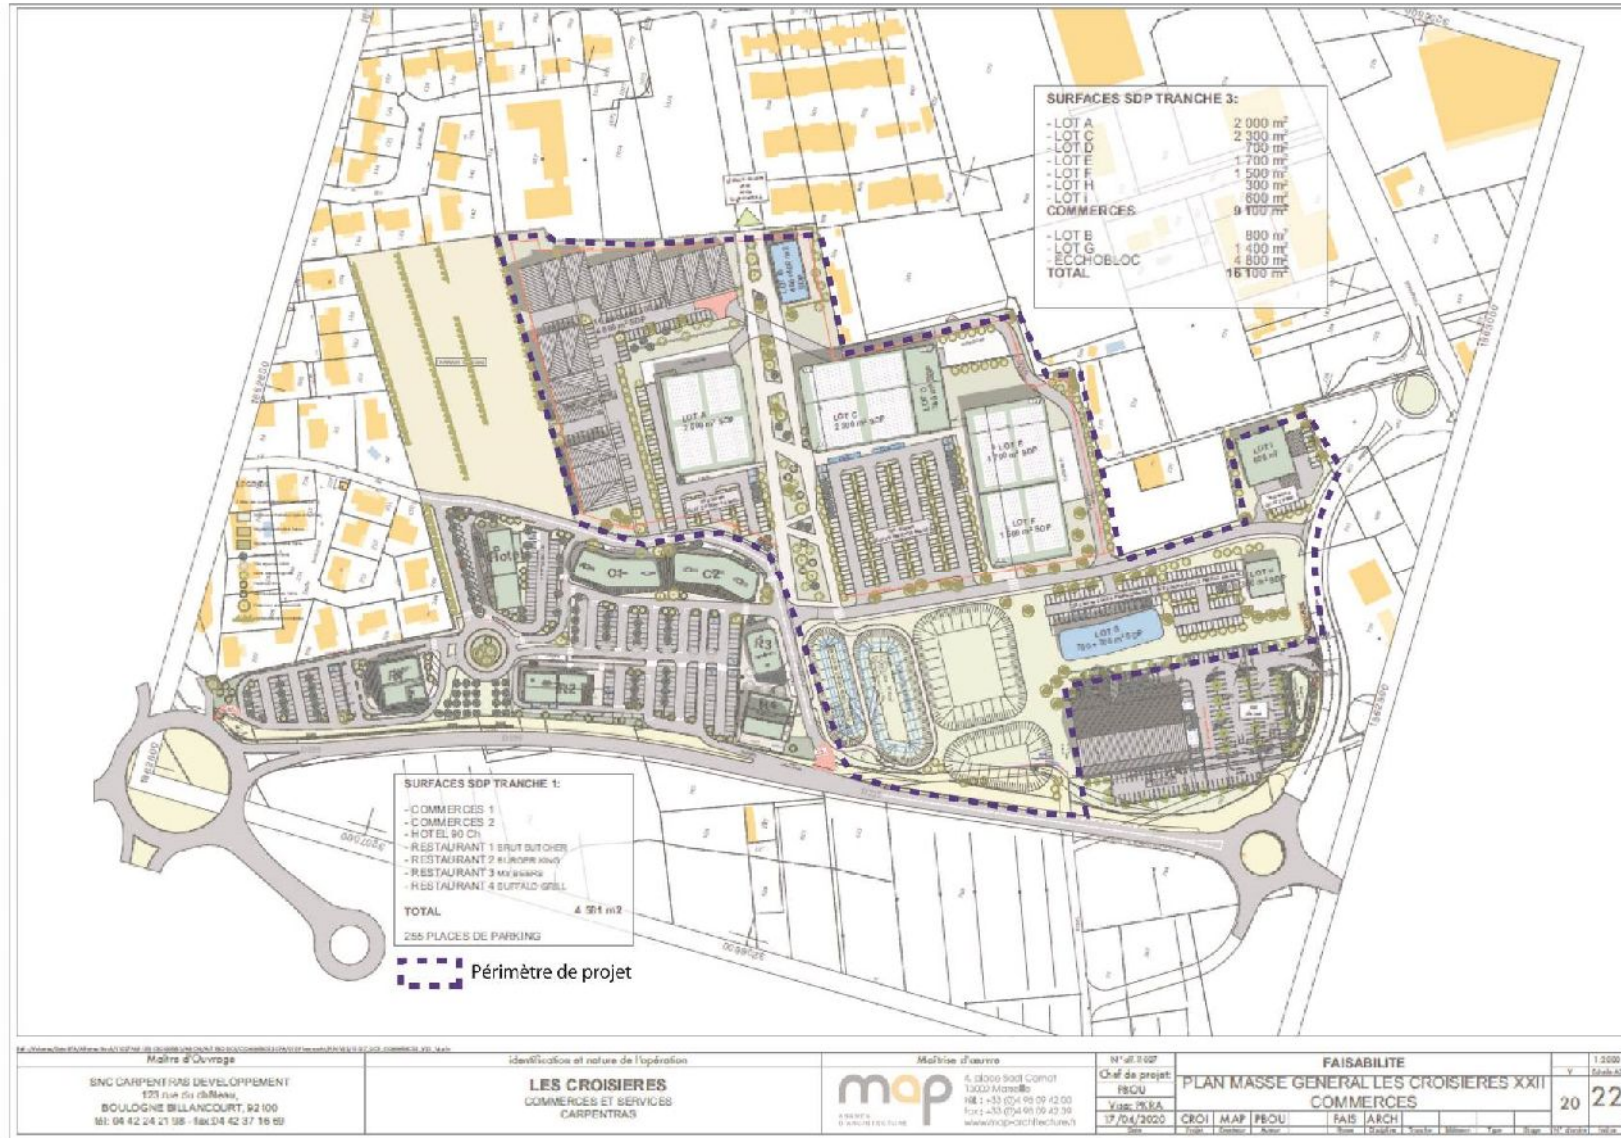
Plan de masse (Source : SNC Carpentras Développement)
